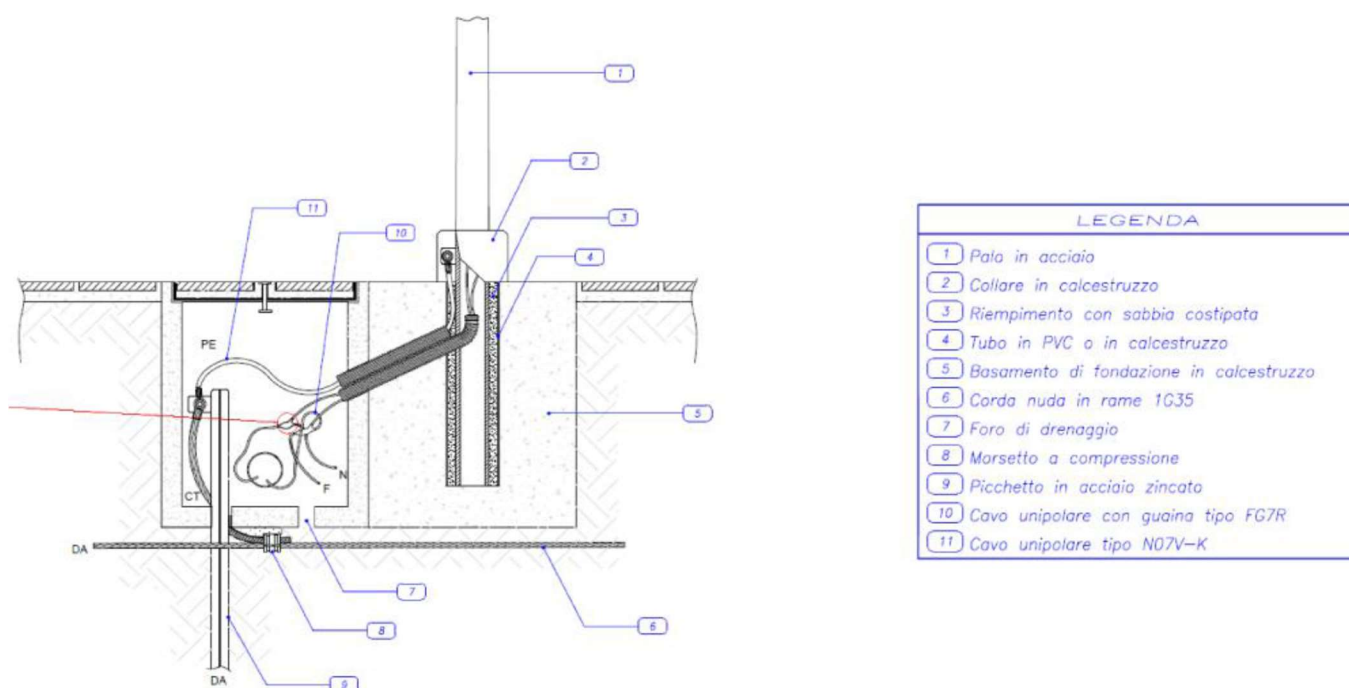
particolare del collegamento tra pozzetto e palo e vista del plinto di fondazione
